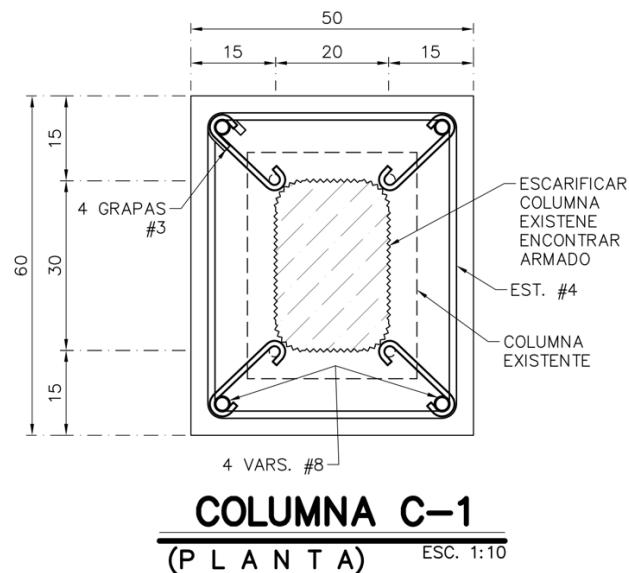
Encamisado de concreto en columna en donde se propone un escarificado de columna hasta descubrir el armadura de refuerzo del elemento. Obtenido de planos de rehabilitación de escuela del Programa de Actualización, (ISC, 2021).
